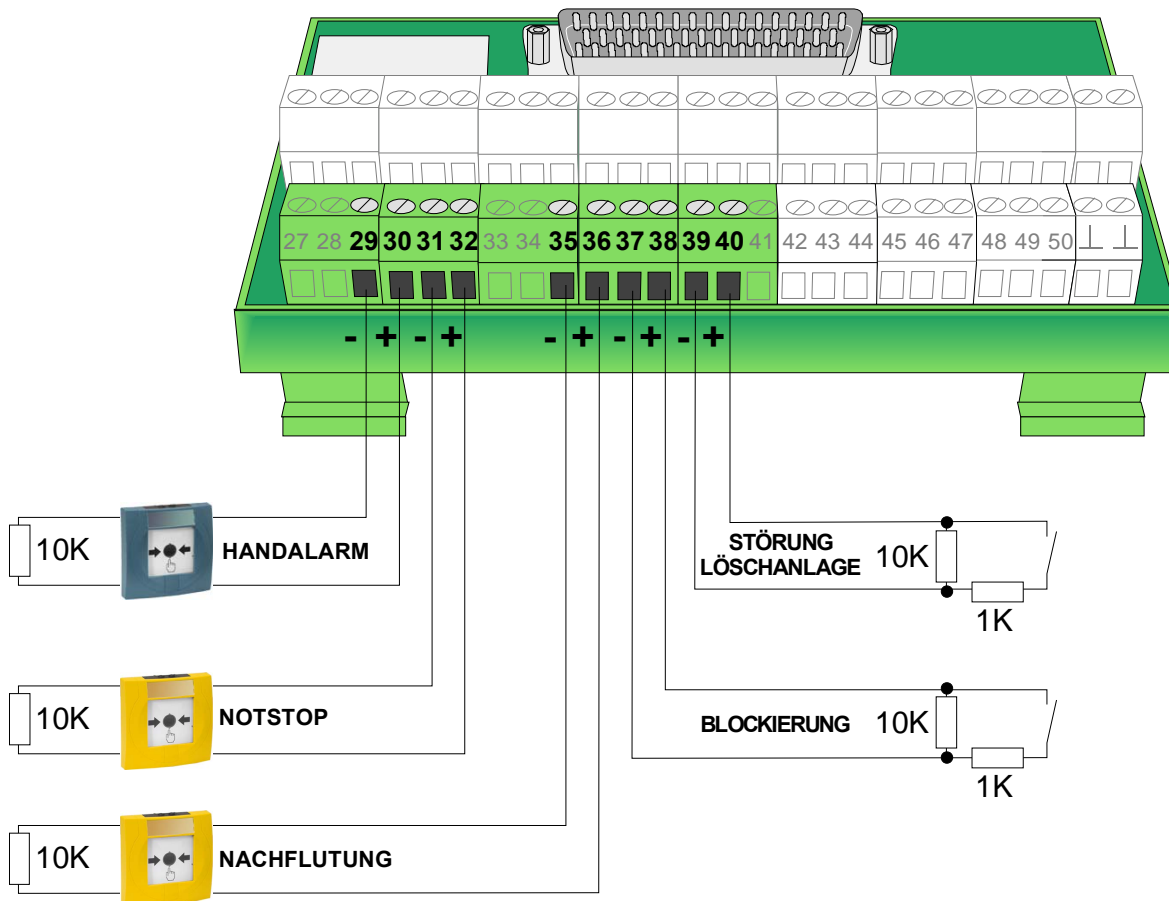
Beschaltung der technischen Gruppen auf der Gruppen-Anschluss technik (Typ Phoenix / Weco)
